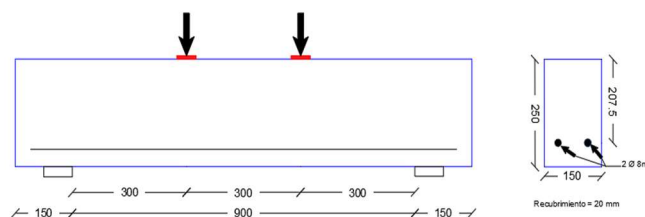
Vista frontal y en corte de las vigas ensayadas.
